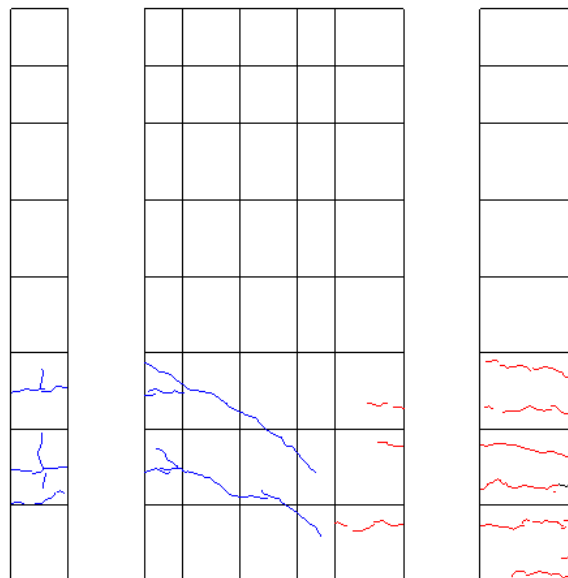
R=1/400 ひび割れ図
